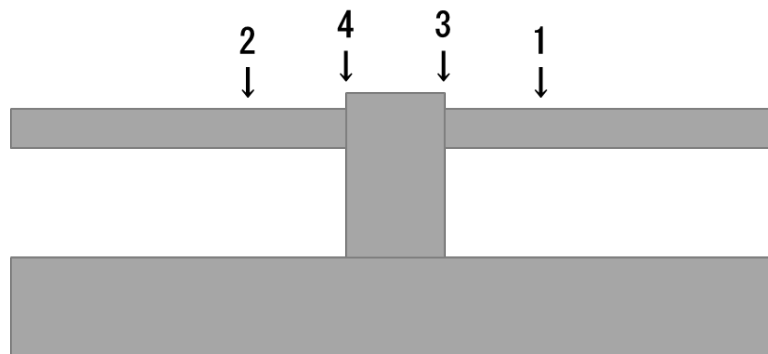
試験体 CA, CB ひび割れ図
